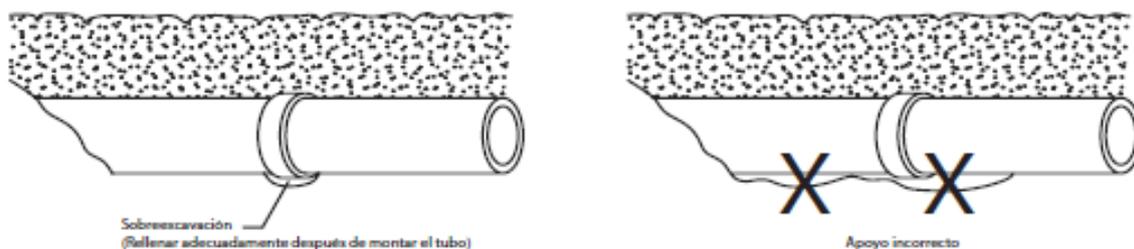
Detalle de rebaje de la cama de tubería en uniones y cama uniforme. Apoyo incorrecto.
